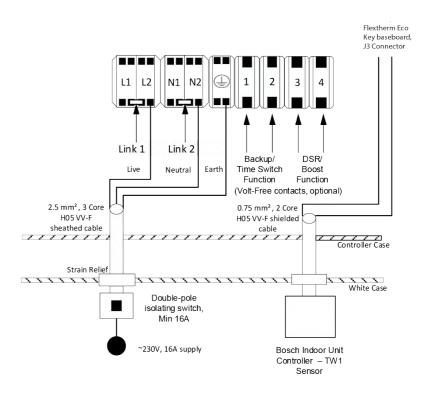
Flextherm Eco G2 D mit Bosch HP-Key
